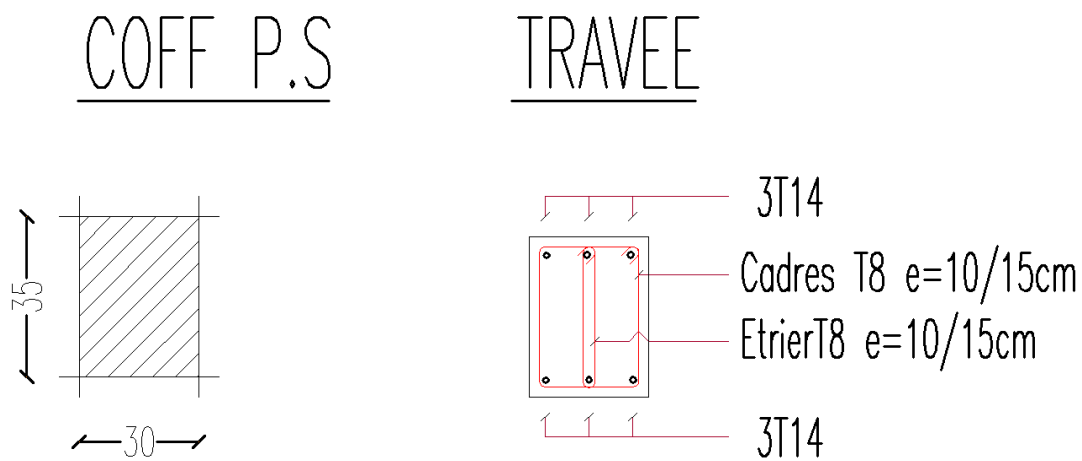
Schéma de ferrailage des poter scendare 30x35
